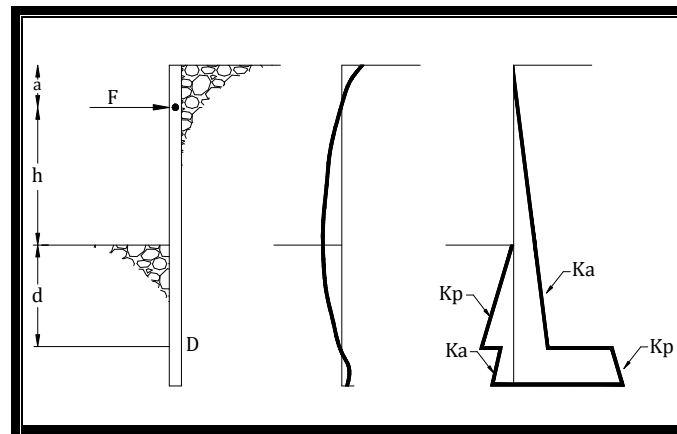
Diaframma con ancoraggio in testa e sezione di base fissa. Deformata e spinte.
